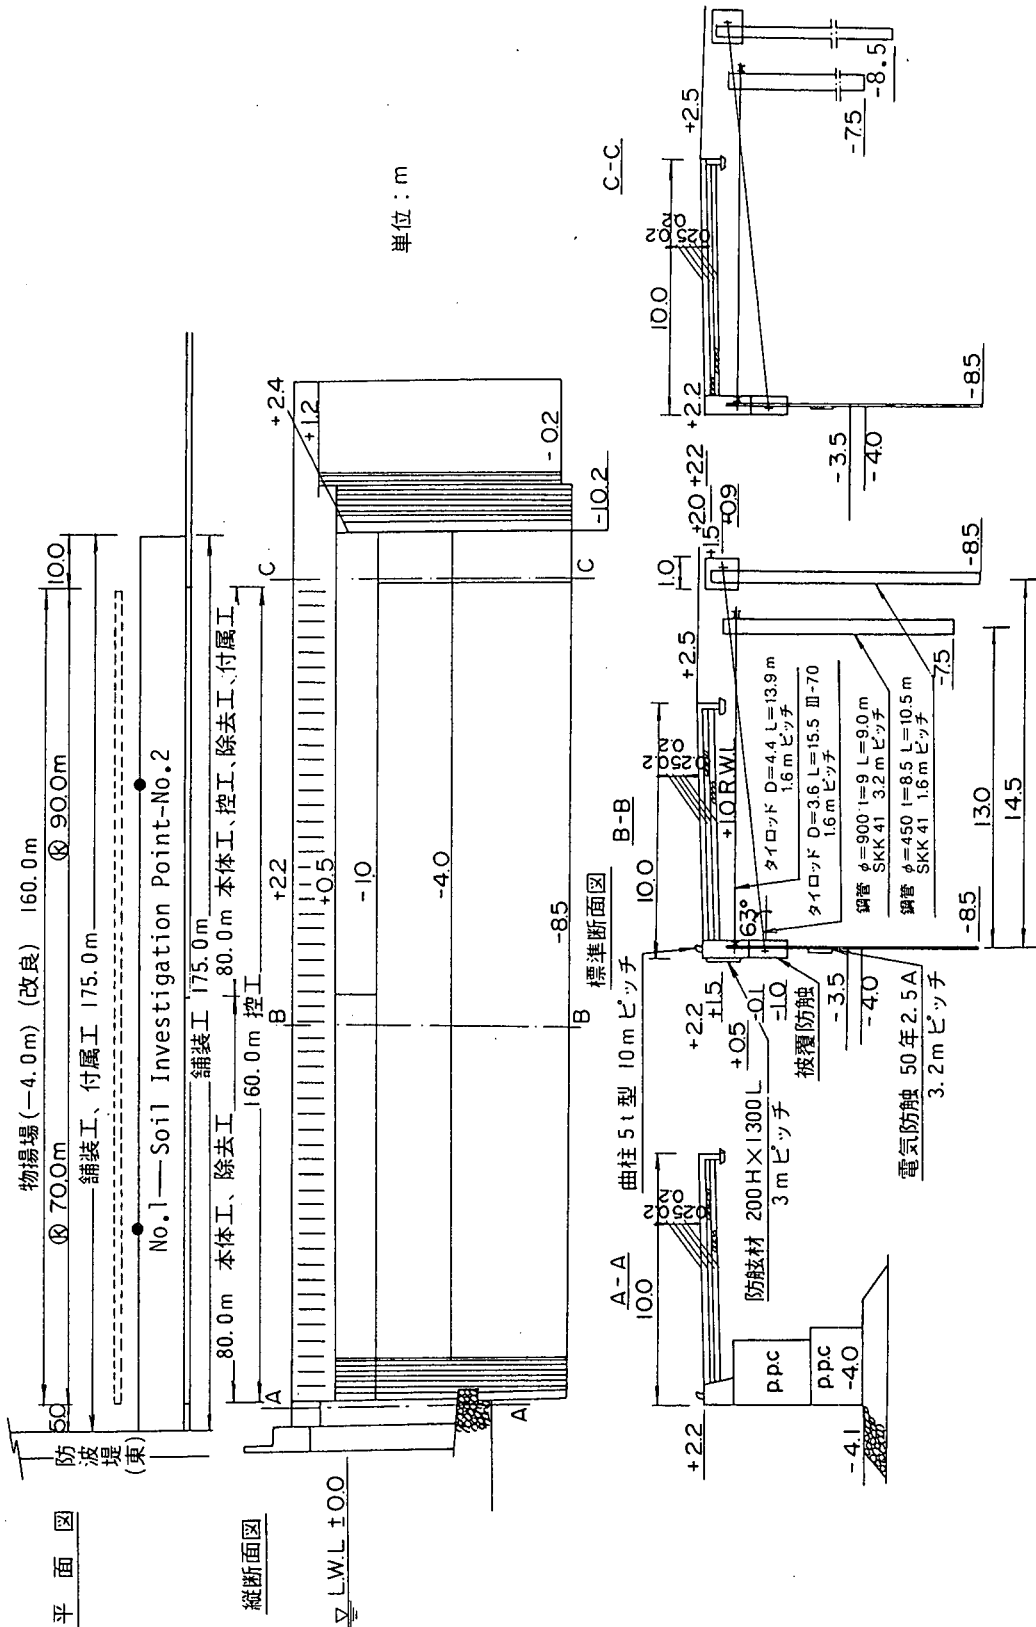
森港第1洞内物揚場 (-4.0m) 平面図・縦断面図・標準断面図
